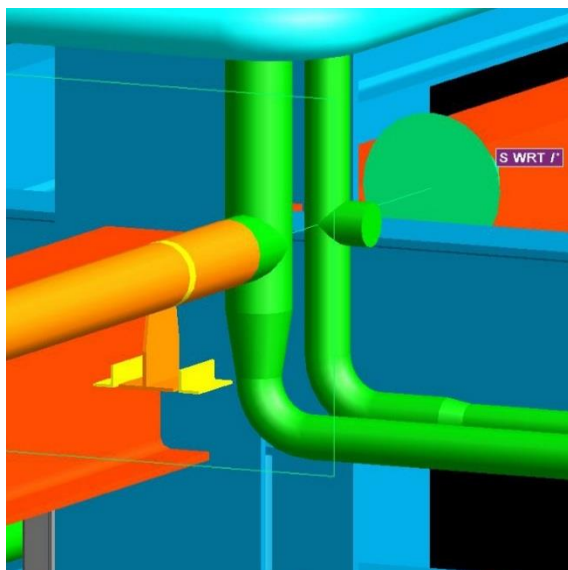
Makro pro posunutí potrubí „Drag move“
